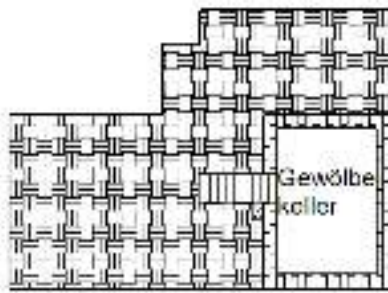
Grundrisssskizze Kellergeschoss
